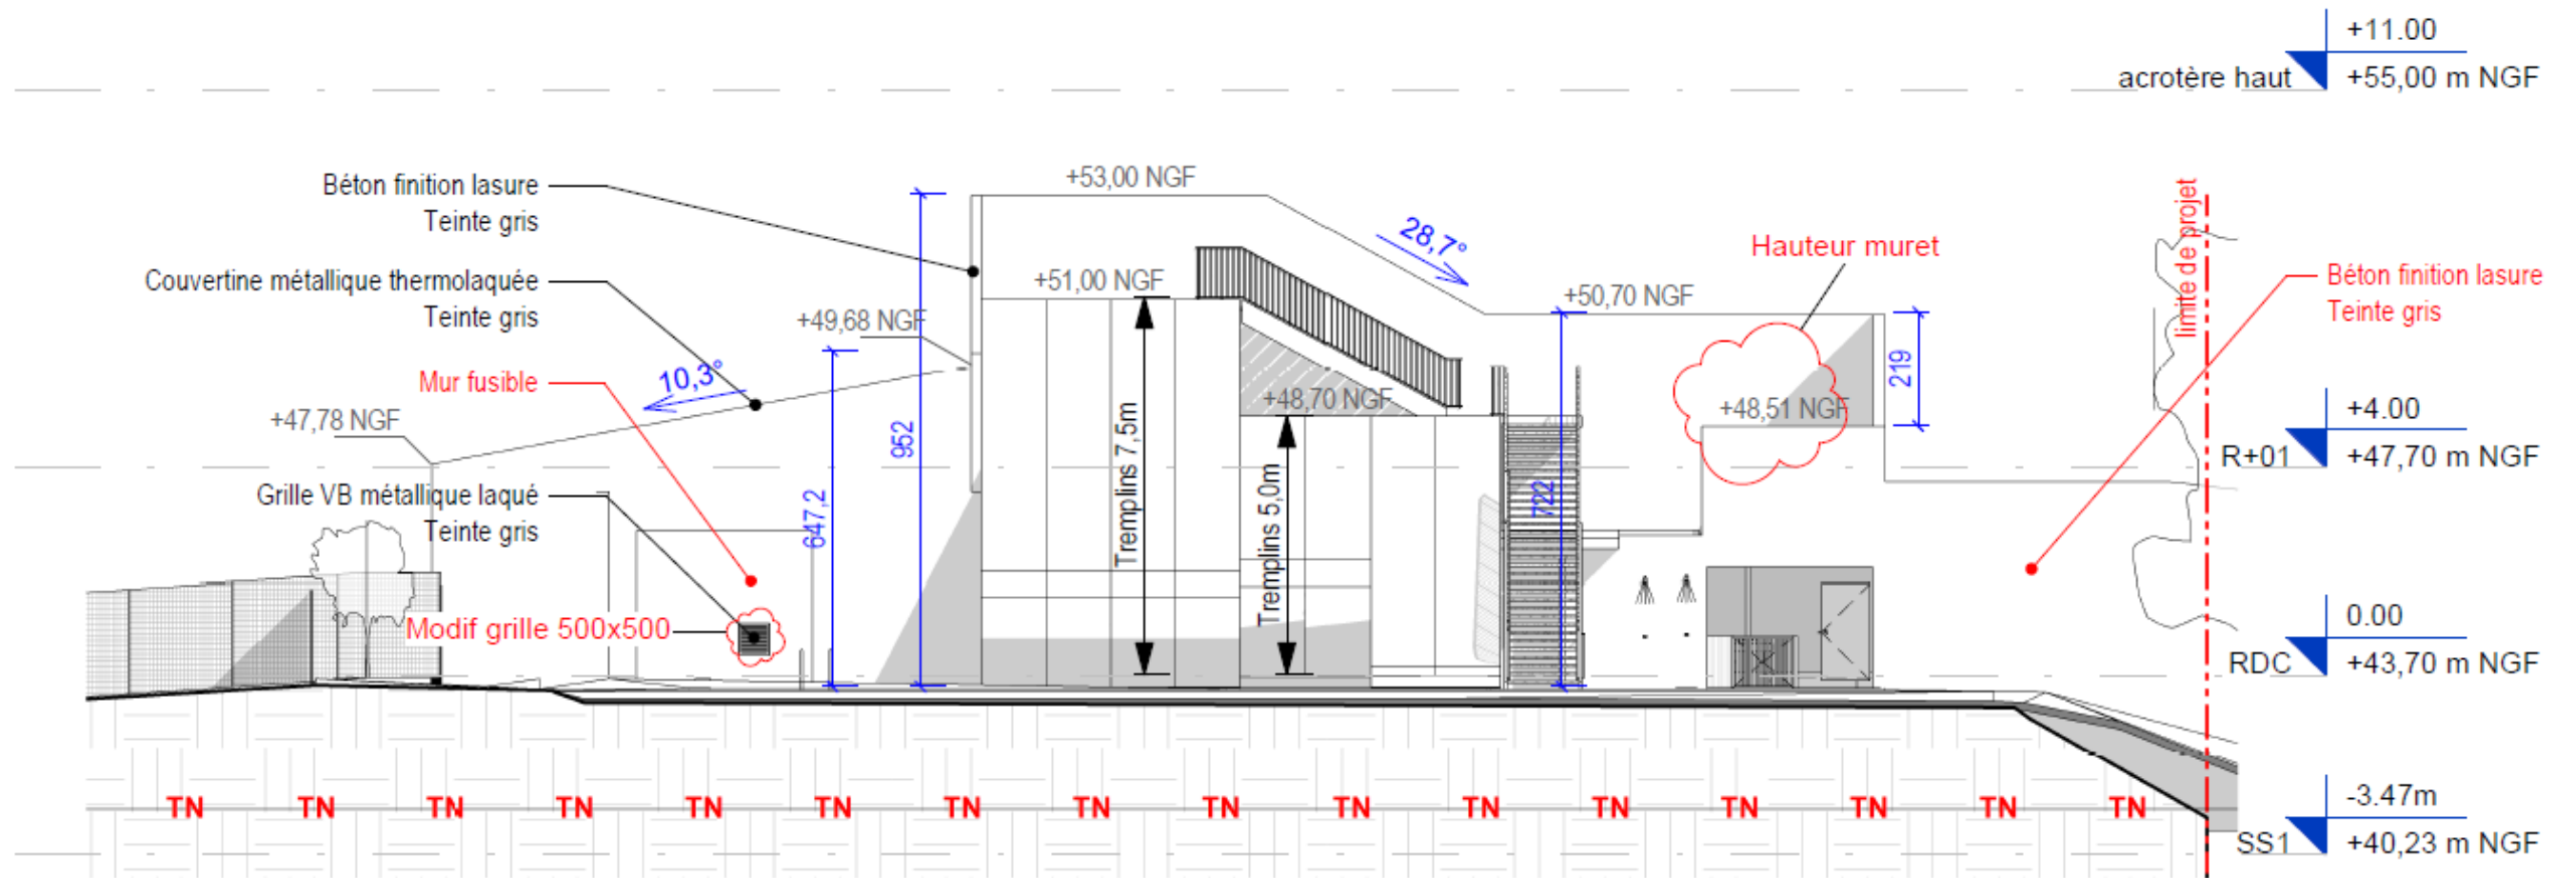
Plan de façade du Waterjump Sud. Source : PCM2
